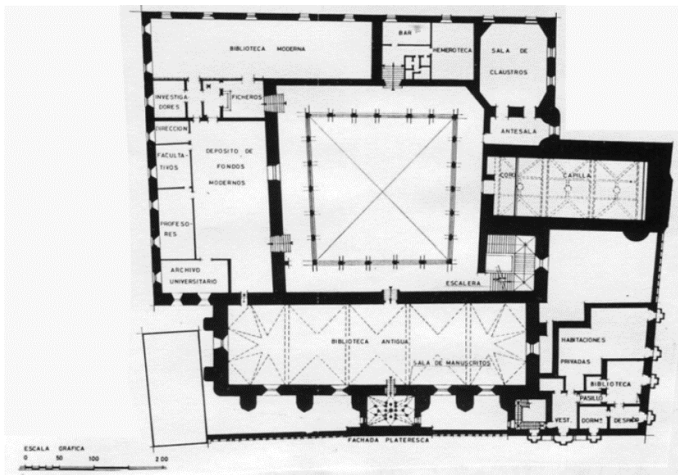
las Escuelas Mayores*: primo piano – planimetria di Ildefonso Gago¹⁸¹
